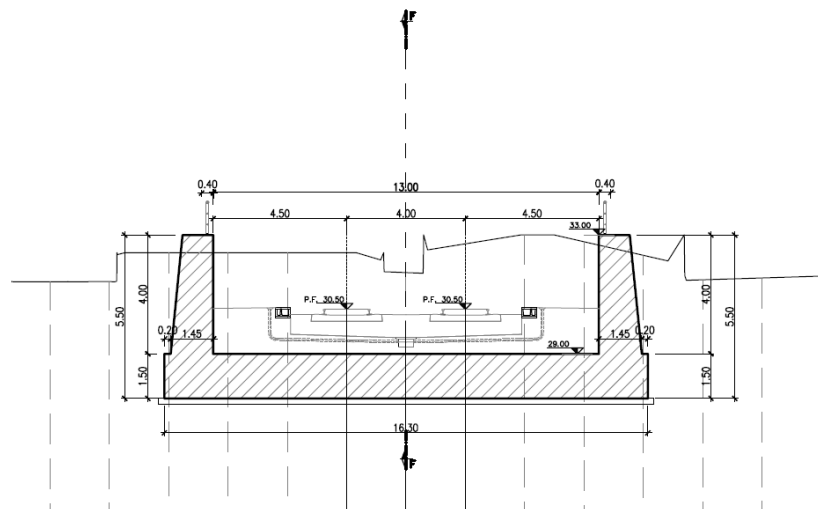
Sezione muro di imbocco (Hmin=4.00 m)
